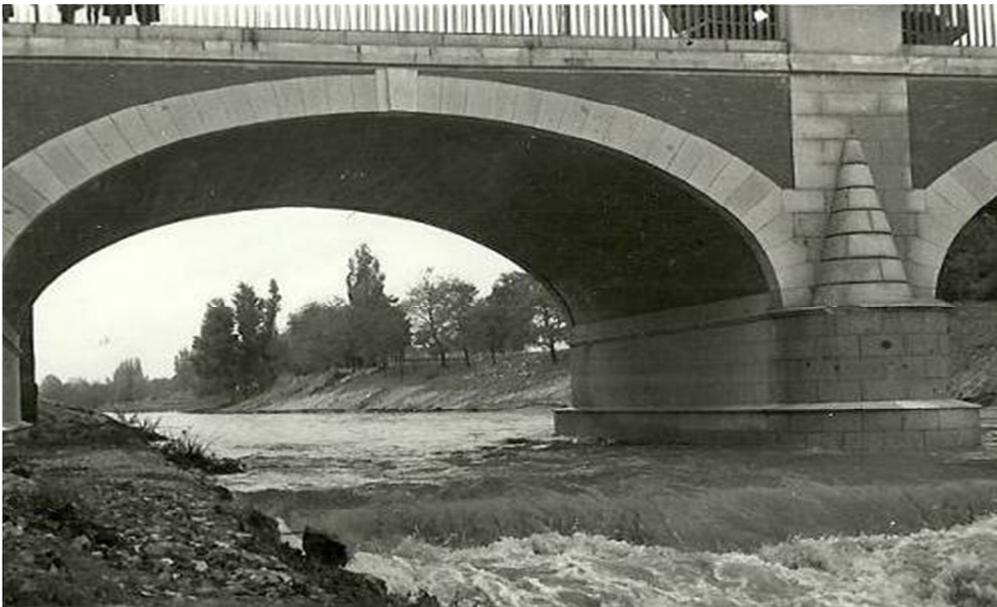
Puente de los Capuchinos (1961) inmediatamente después de su reconstrucción.
